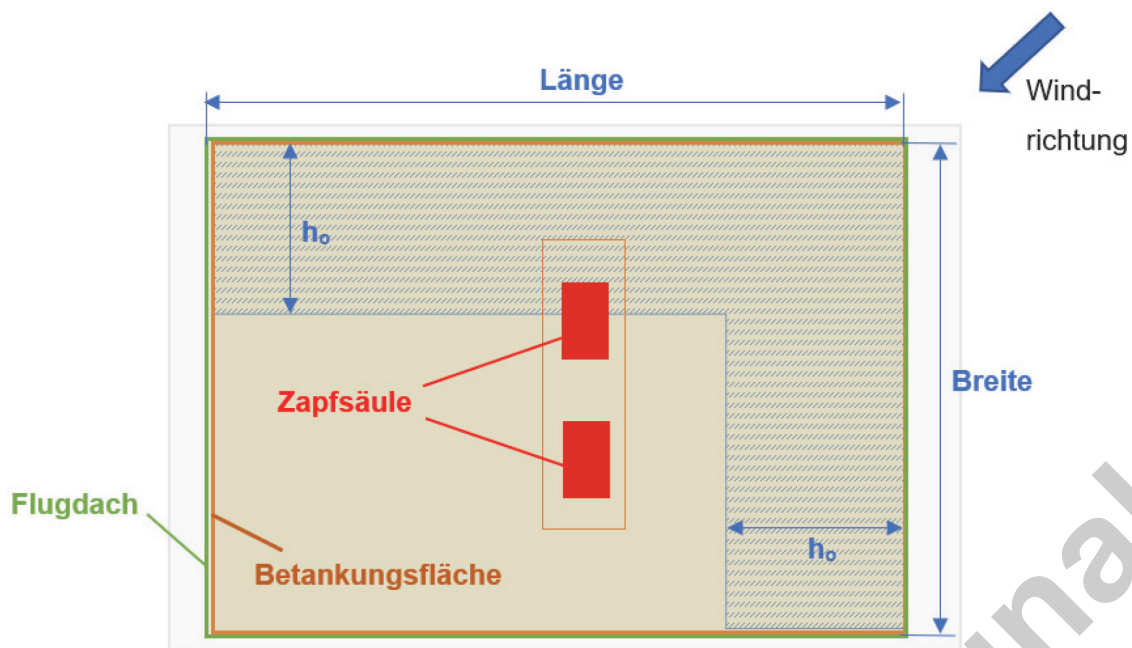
Systemdarstellung (Grundriss): beregnete Fläche bei Tankstellen mit Flugdach
